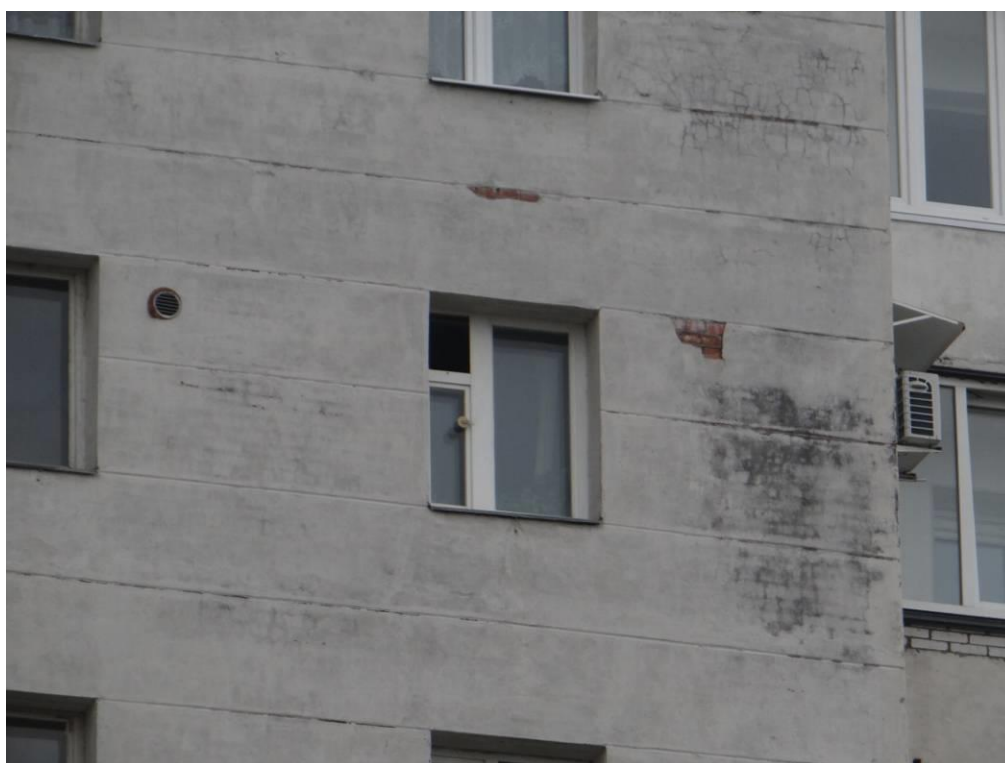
Фрагмент фасада по оси «1» на участке в осях «Г» - «В» в уровне 8 этажа. Следы увлажнения поверхностей фасада, приуроченные к подоконным отливам. Сети разнонаправленных трещин в штукатурном покрытии. Участки обрушения штукатурного покрытия. Морозное разрушение материалов кирпичной кладки.
